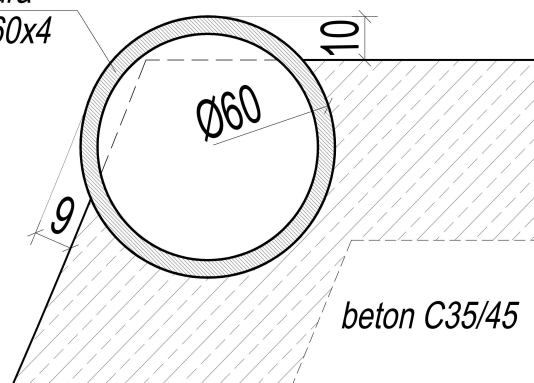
Profil równo „wtopiony” w krawędź elementu. Do profilu przyspawane marki z drutu stalowego w celu pewnego zakotwienia w betonie
